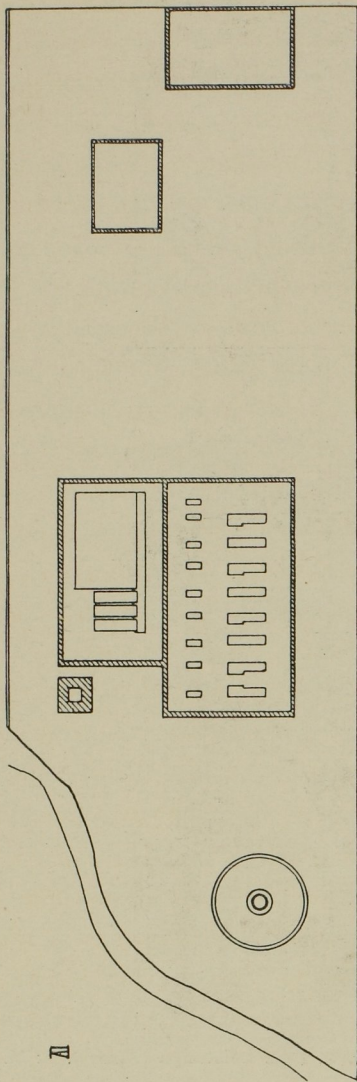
Lageplan der Pumpstation des Radialsystems IV.
